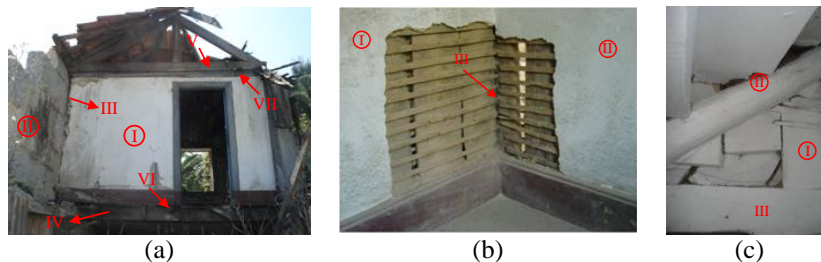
Pormenores construtivos; (a) ligação entre uma parede divisória de tabique e uma parede exterior de alvenaria de pedra; (b) ligação entre uma parede divisória de tabique e uma parede exterior de tabique; (c) ligação entre parede divisória de tabique e uma escada de madeira
